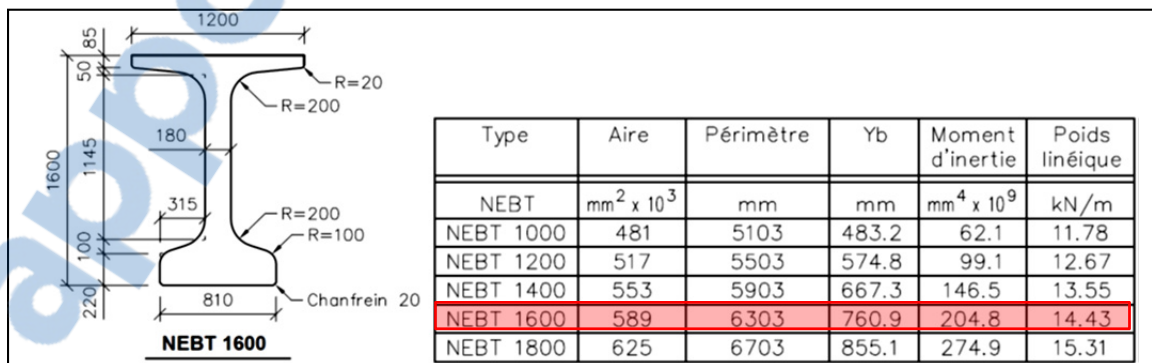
Dimensions et caractéristiques de la poutre préfabriquée NEBT 1600
